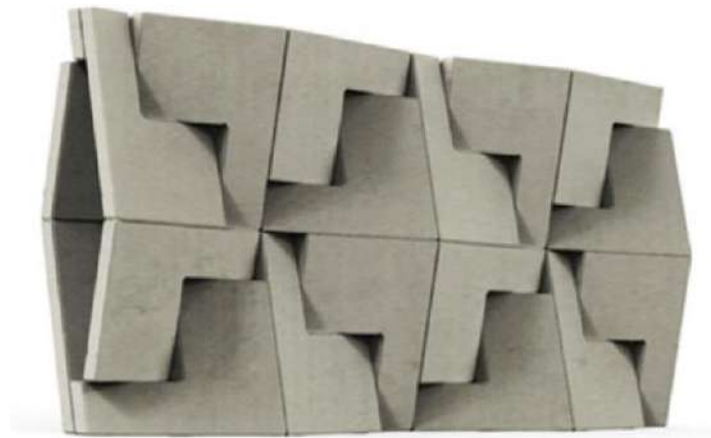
Muro sistema constructivo plegable. (iarquitectos, 2012)
